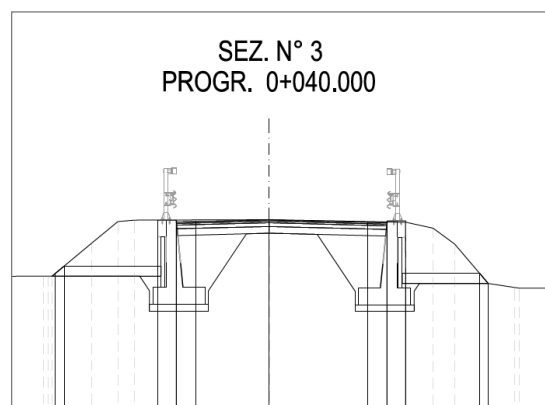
Sezione del rilevato su lato nord in approccio al nuovo ponte di Final di Rero (via del Mare)
